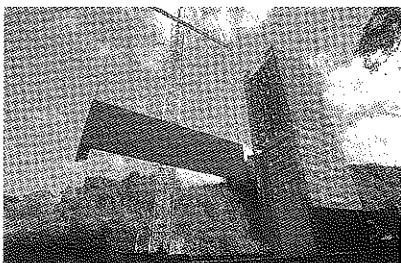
飯牟礼2号橋の施工状況（矩形断面）
